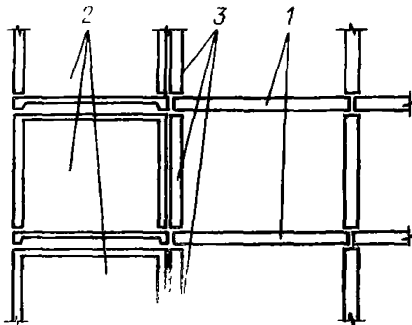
Схема опирания панельных перекрытий на панельные стены (фрагмент продольного разреза здания)
